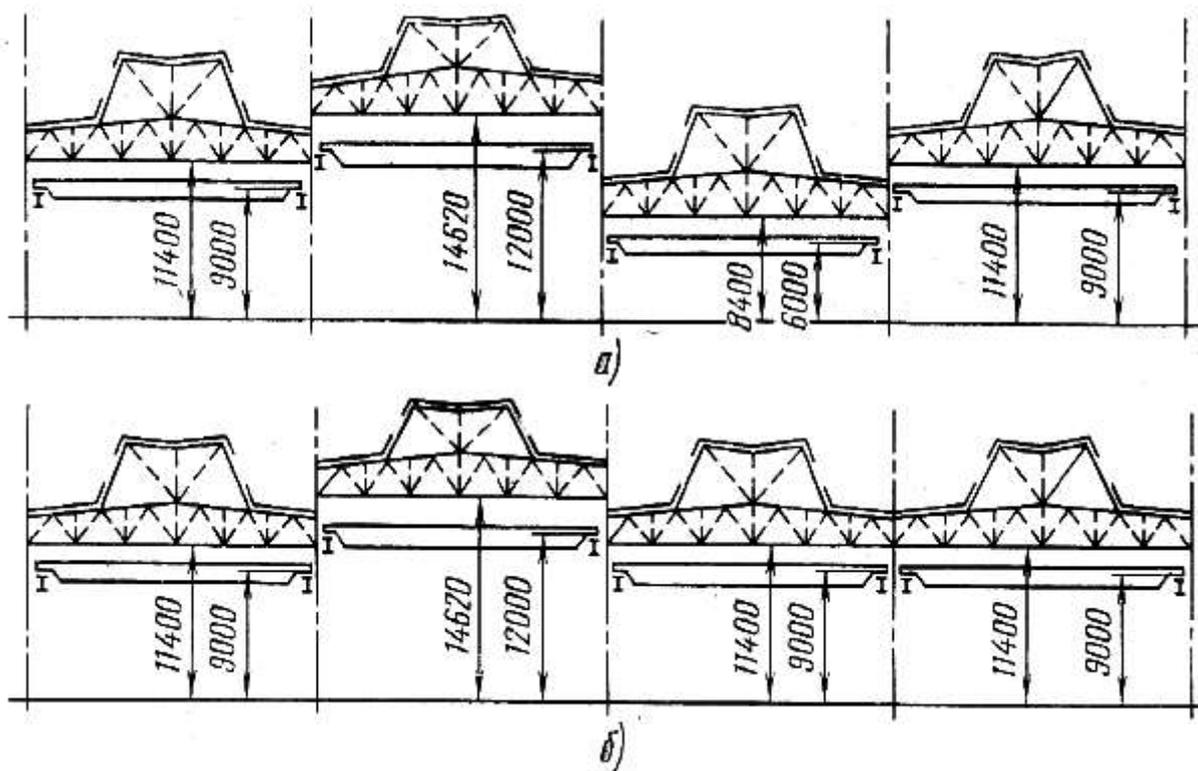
Поперечное сечение пролетов узловой сборки и сварки при планировке цеха со смешанным направлением производственного потока: *а* – неправильно; *б* – правильно
